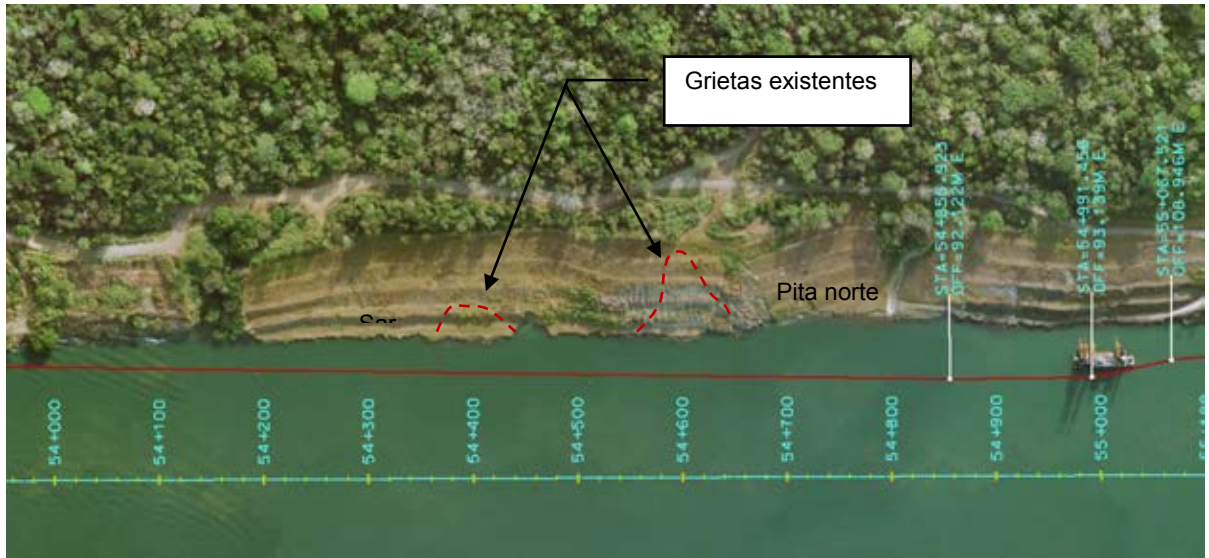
Planta de ubicación de deslizamientos en La Bordada Cascadas
